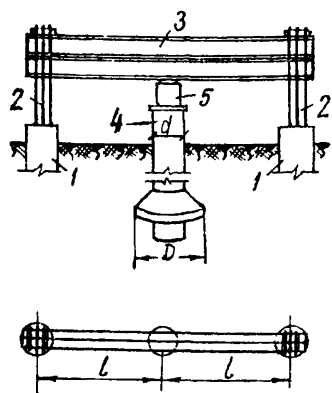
Схема испытательной установки с двумя анкерными сваями:
